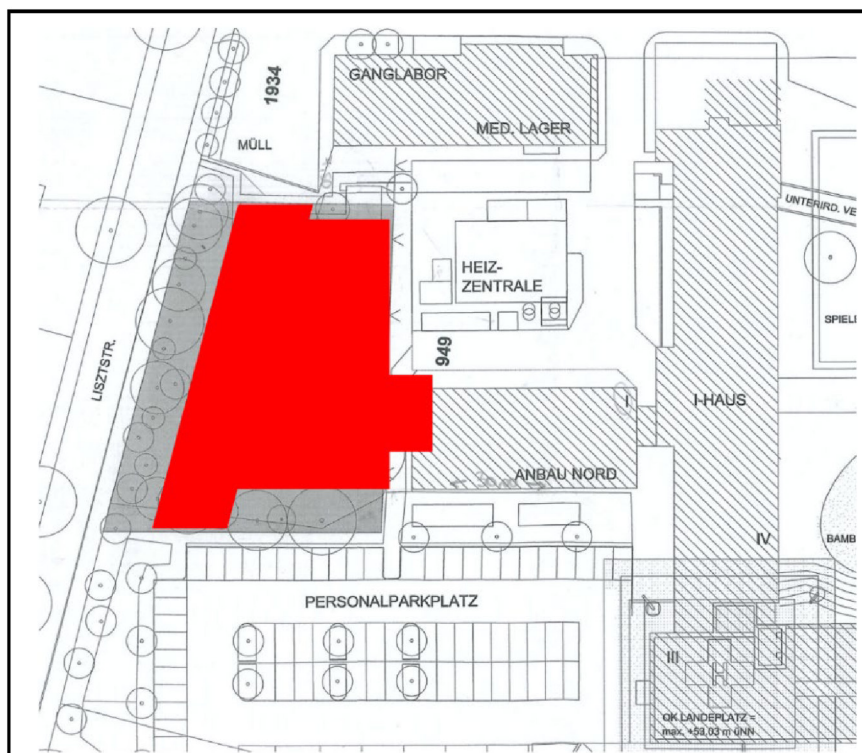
Lage des Reha-Gebäudes auf dem Gelände des AKK, Quelle: Lageplan /2.5/
